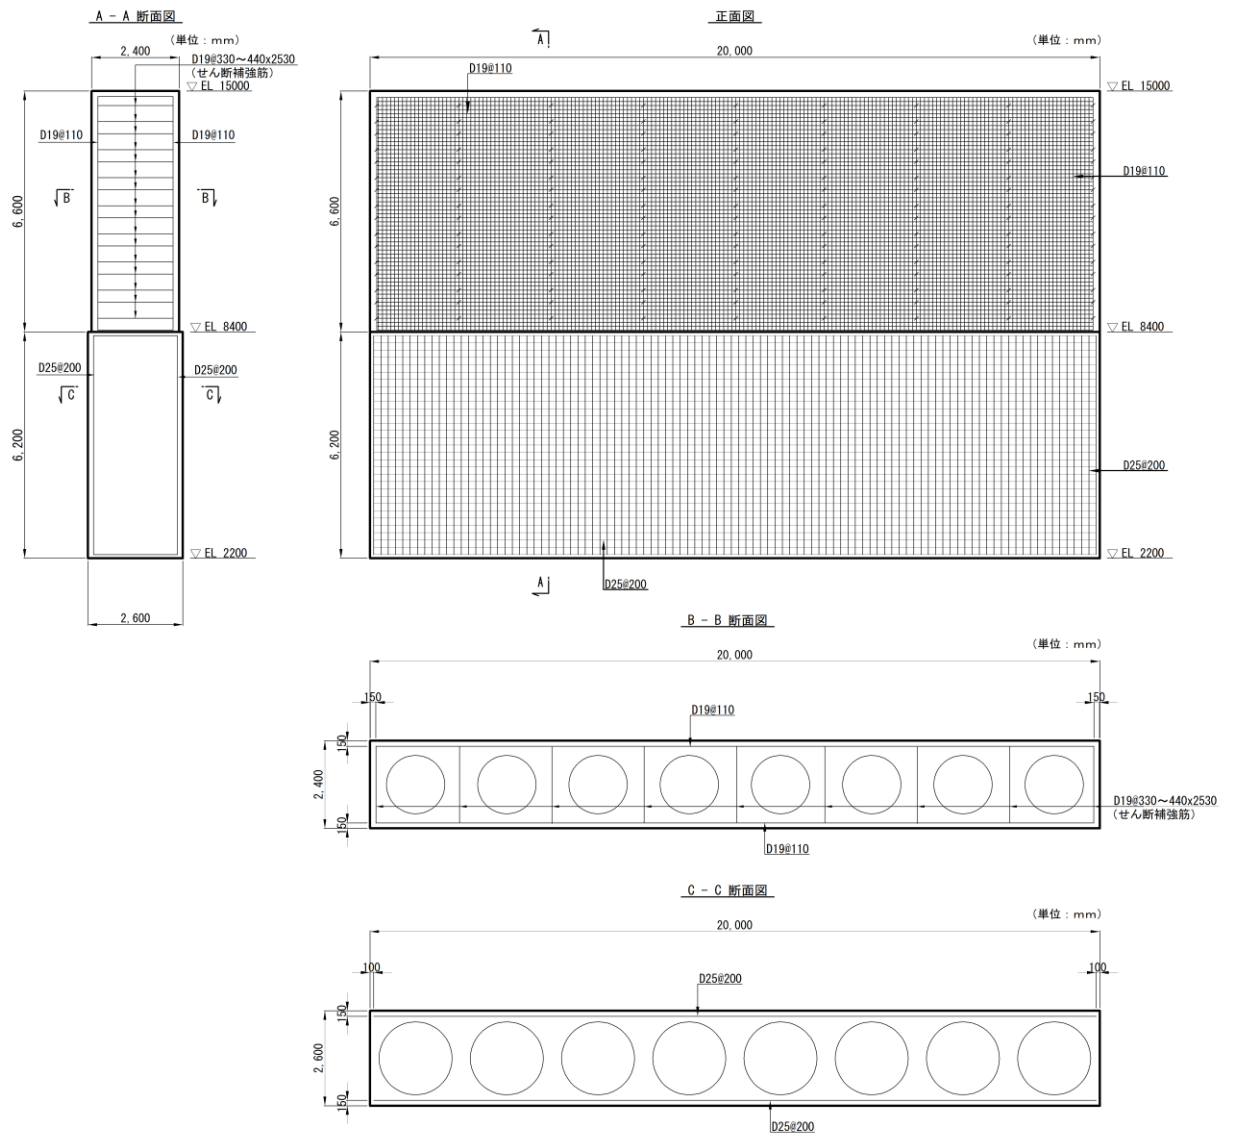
被覆コンクリート壁の概略配筋図 (③-③断面)
